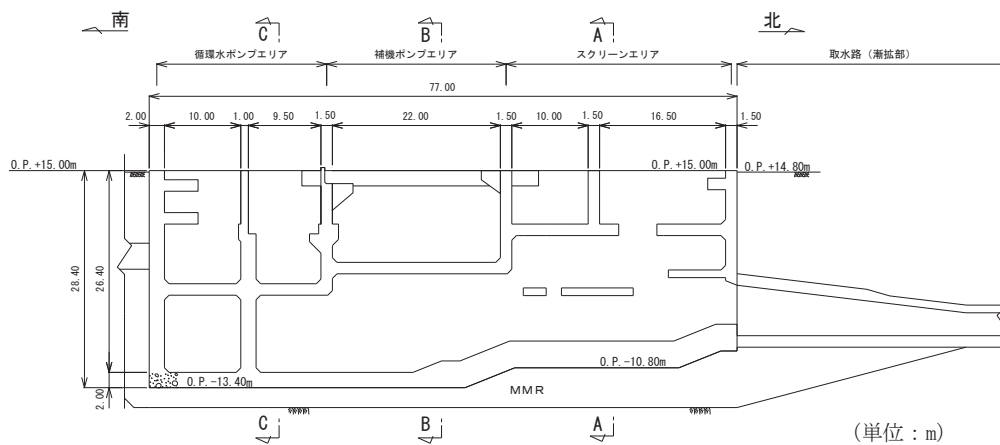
海水ポンプ室断面図 (E-E 断面, 南北)
